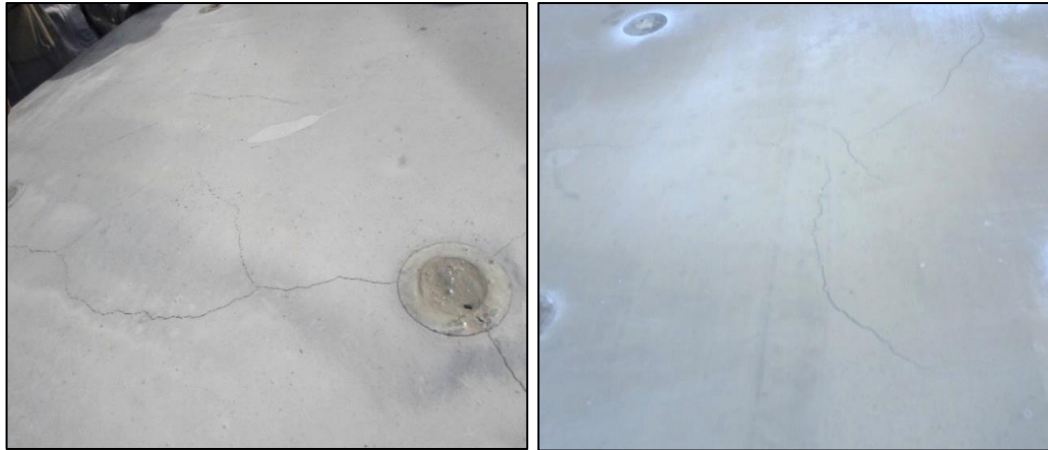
GC1 incremento de las fisuras en cantidad y dimensión.
